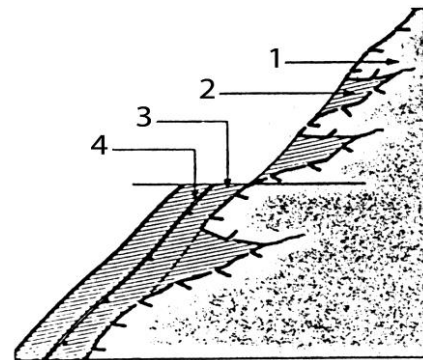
Конструктивне рішення з'єднання скали торкрет-бетонним покриттям. 1 – скала; 2 – заповнення щілини; 3 – торкрет-бетонне покриття; 4 – арматурна сітка.
